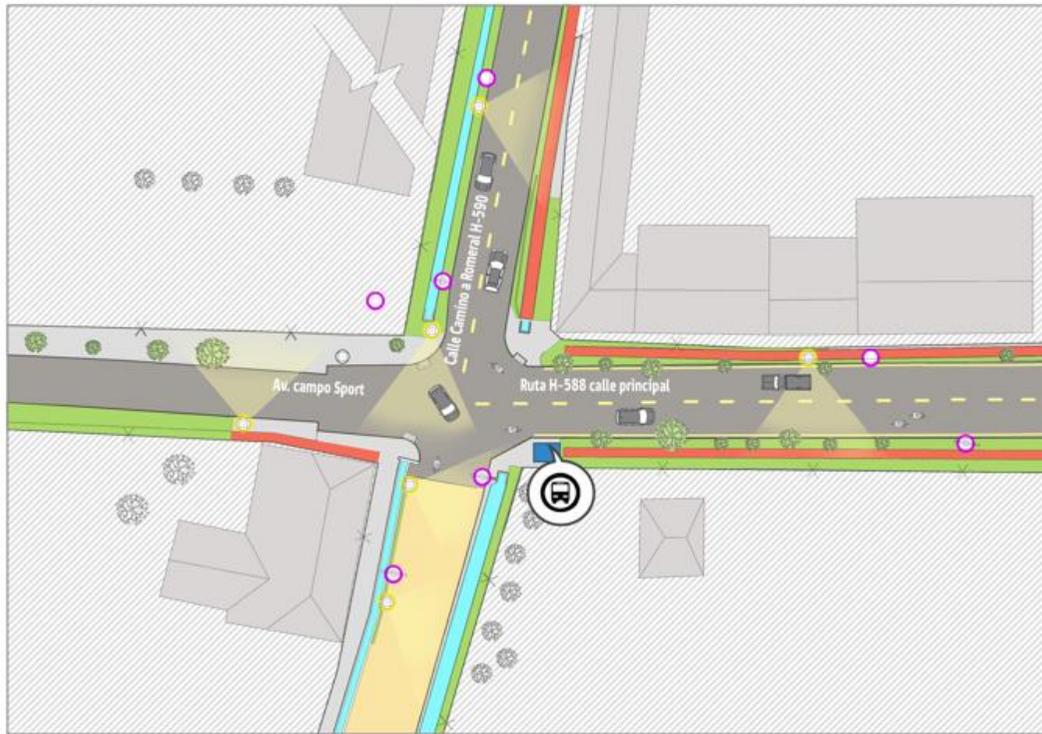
Planimetría vialidad, señalización, iluminación y postación ZT Pueblo de Zúñiga. OTR OH CMN, 2024.
